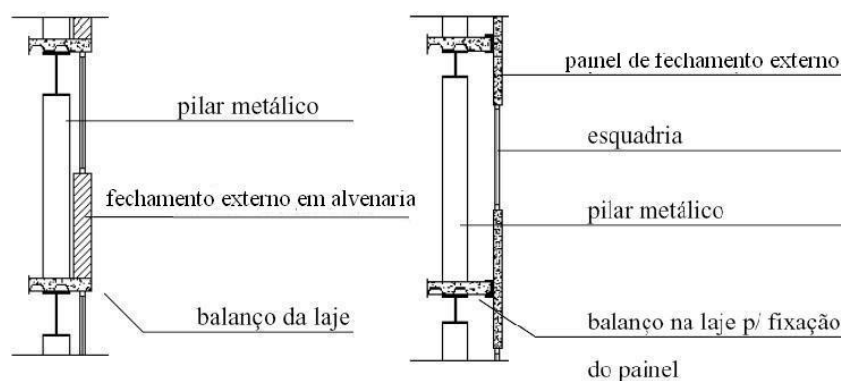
Esquemas de desvinculação entre alvenaria externa e estrutura metálica
